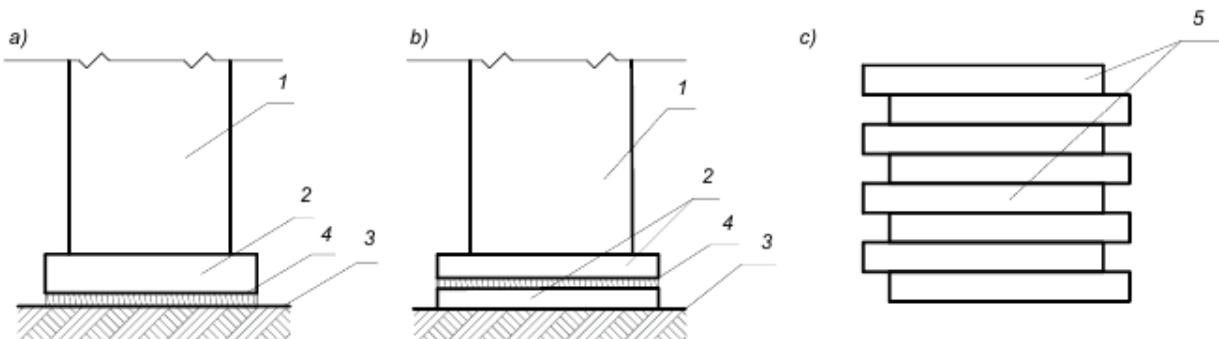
Система инженера Ф.Г. Габибова: *a* – скользящий слой между подошвой фундамента и основанием; *b* – слой внутри тела фундамента; *c* – собранный элемент мата; 1 – стена; 2 – фундамент; 3 – основание; 4 – маты
